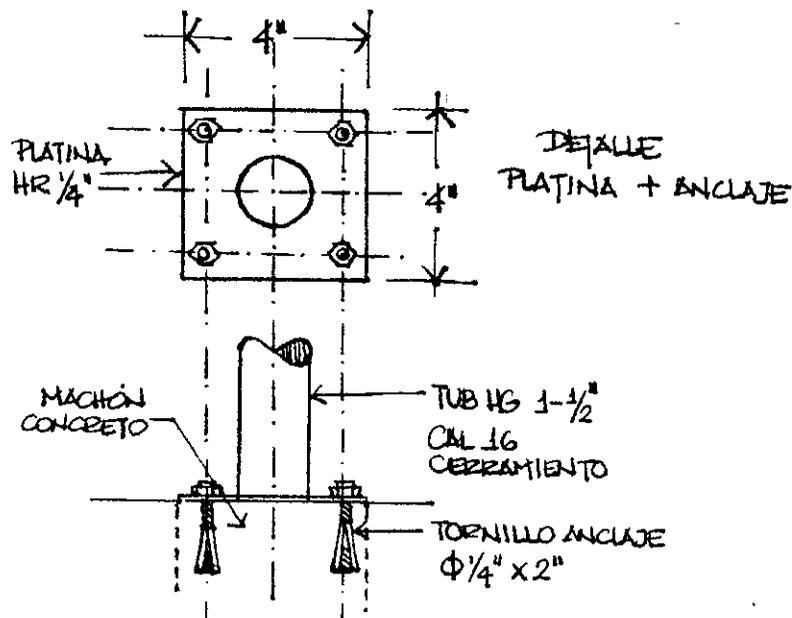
Detalle del empalme del paral y el anclaje con tornillería con encamisado expansible.
